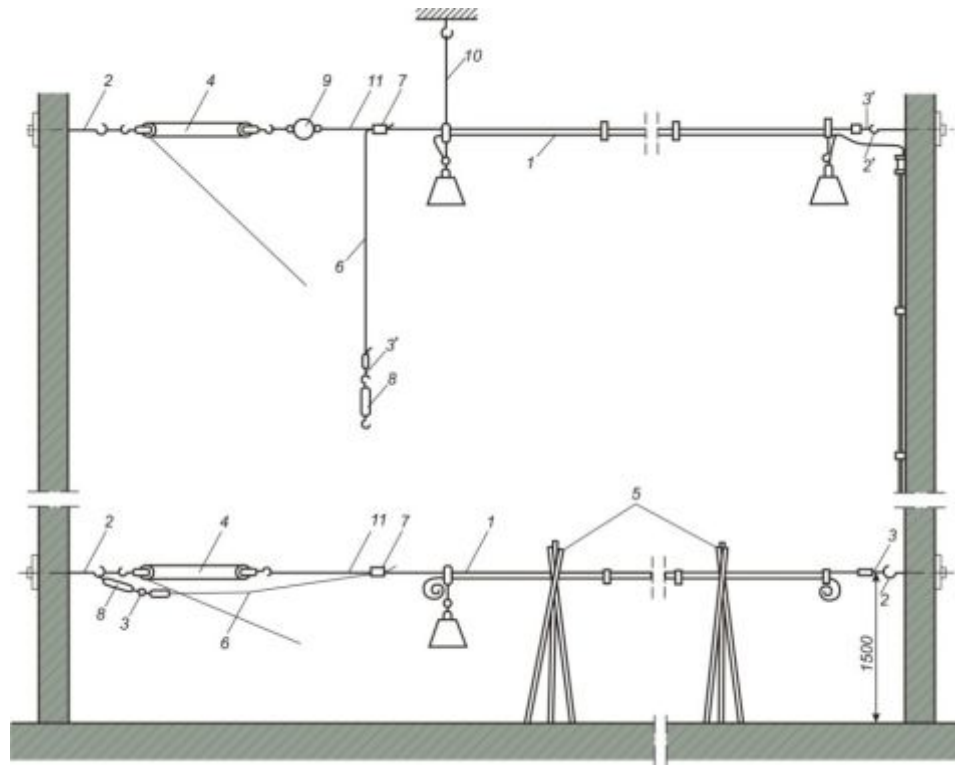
Схема сборки и подвески тросовых электропроводок на месте монтажа: 1 – плетень тросовой электропроводки; 2 - 2' – временные анкеры; 3, 3' – концевые петли; 4 – специальная лебедка или полиспаст; 5 – инвентарные подставки; 6 – свободный конец несущего троса; 7 – клиновой зажим; 8 – натяжная муфта; 9 – динамометр; 10 – вертикальные проволочные подвески; 11 – вспомогательный отрезок троса.
